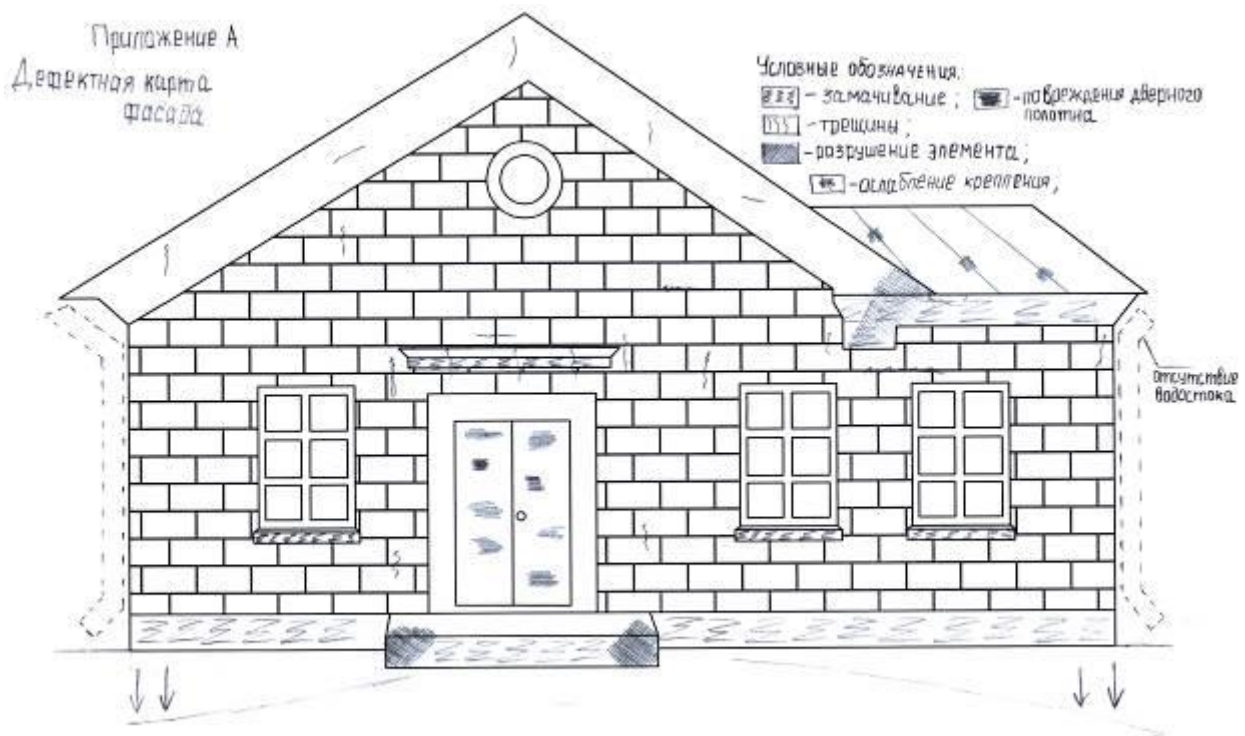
Дефектная карта фасада кирпичного здания.
